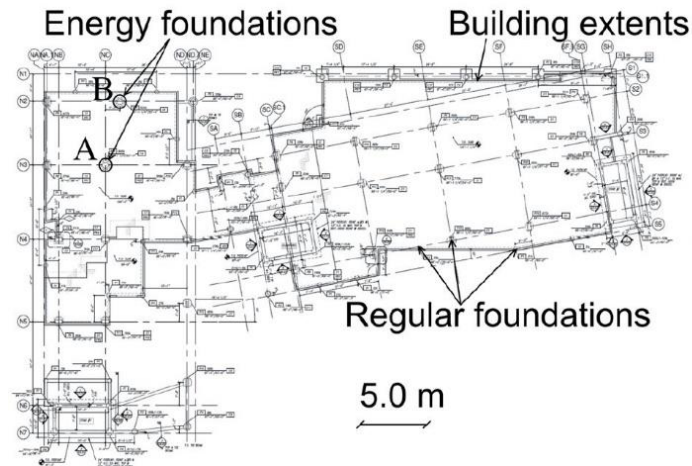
Planta de la cimentación del edificio y localización de los dos pilotes termoactivos (McCartney and Murphy, 2012)
